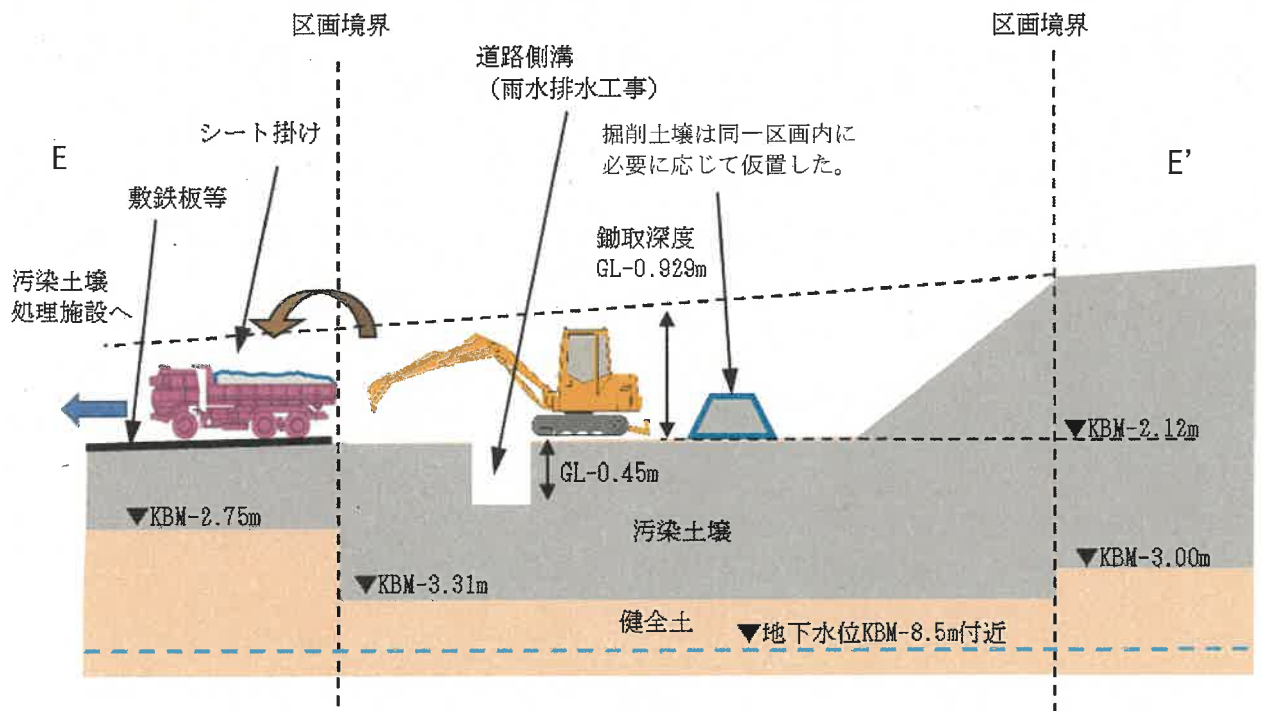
(2) 土地の形質の変更の施工方法を明らかにした断面図 (雨水排水工事, 路盤鋤取り, アスファルト舗装工事) E-E' 断面
